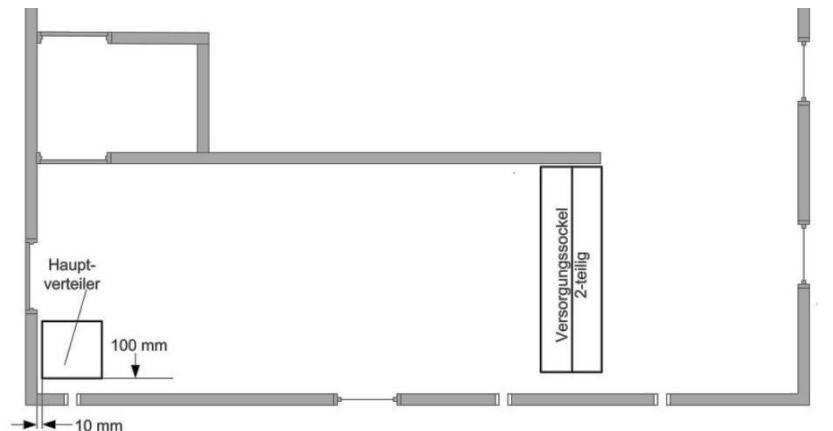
Positionieren des Hauptverteilers im Containerraummodul
